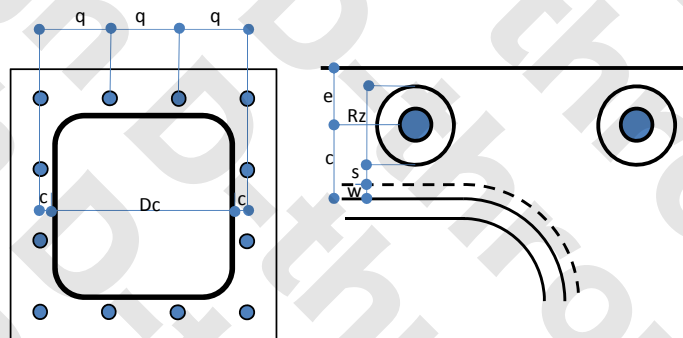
12 本 (均等) タイプのアンカーボルト配置
